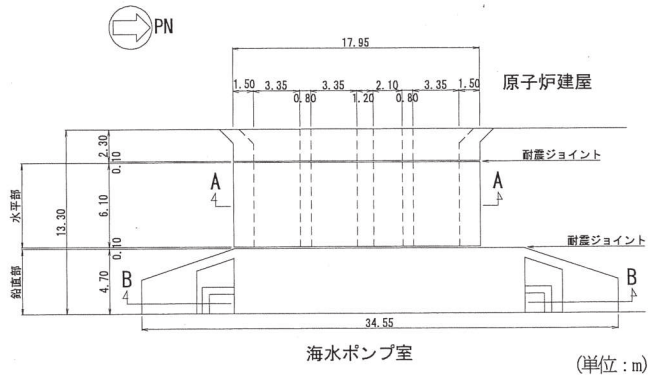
原子炉機器冷却海水配管ダクト平面図
